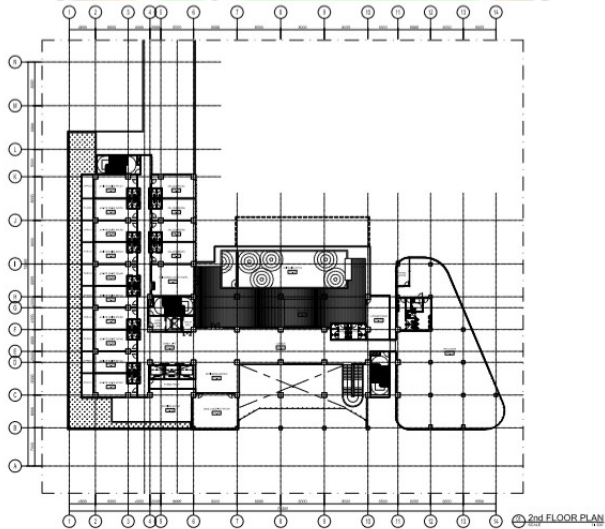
site plan pembangunan Melia International Hotel and Convention Hall
